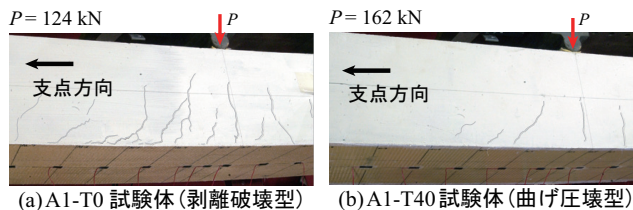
A1 梁の終局時近傍におけるひび割れ性状
